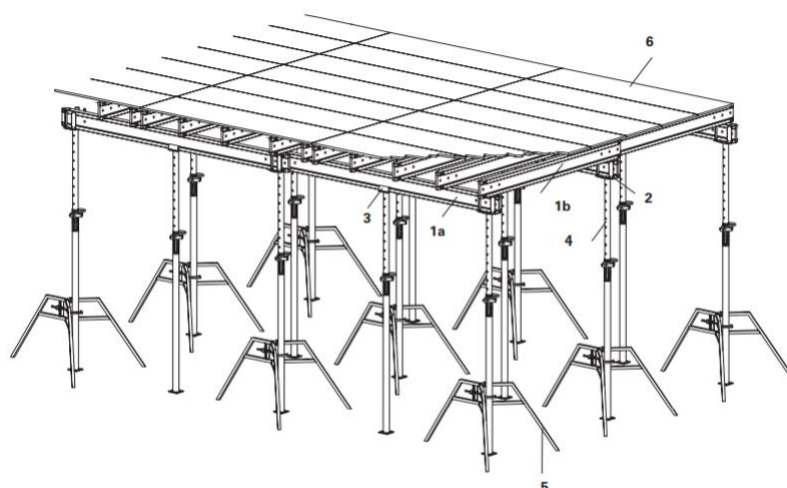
Конструктивные элементы опалубки перекрытия:
